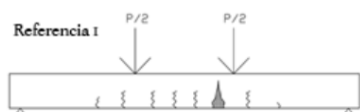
Fuerzas a las que es sometida el elemento de concreto armado.
